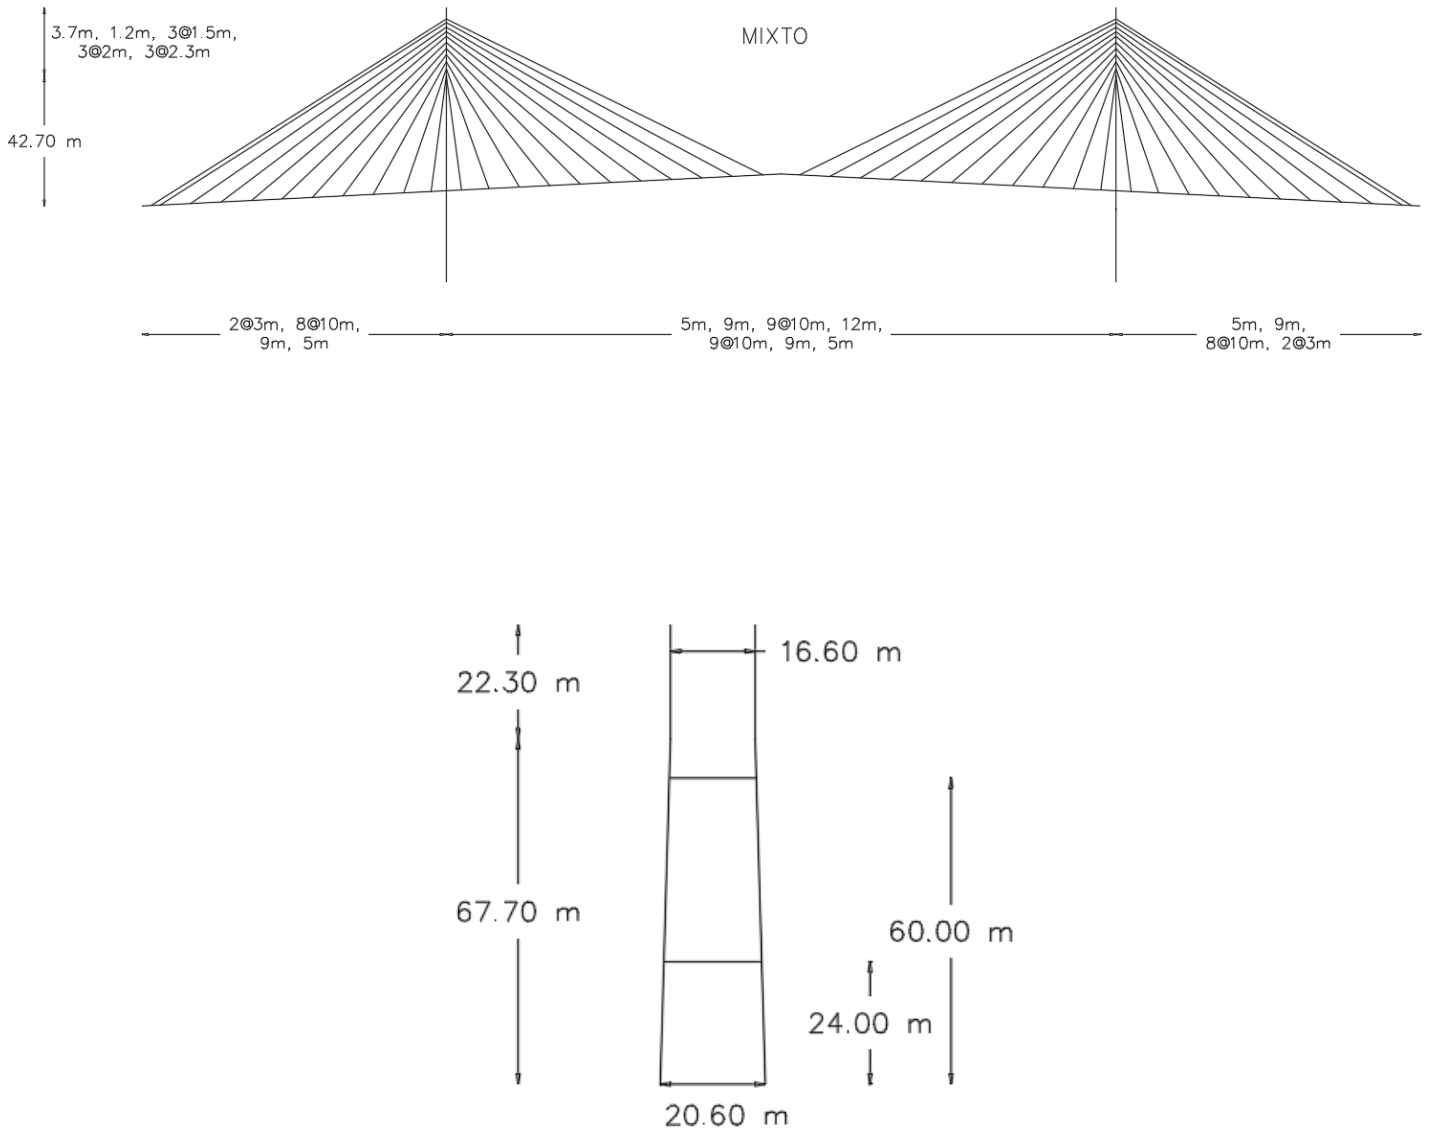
Estructura atirantada según 2 planos laterales, tipología mixta
